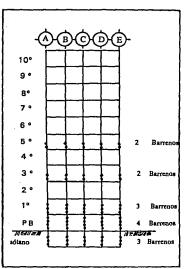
NUMERO DE NIVELES A PREPARAR Y CANTIDAD DE BARRENOS EN CADA COLUMNA
